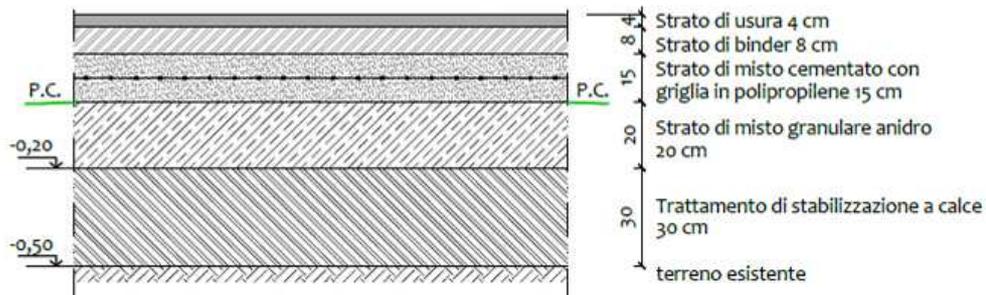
Sezione tipologica 2 e pacchetto di pavimentazione della pista di cantiere
